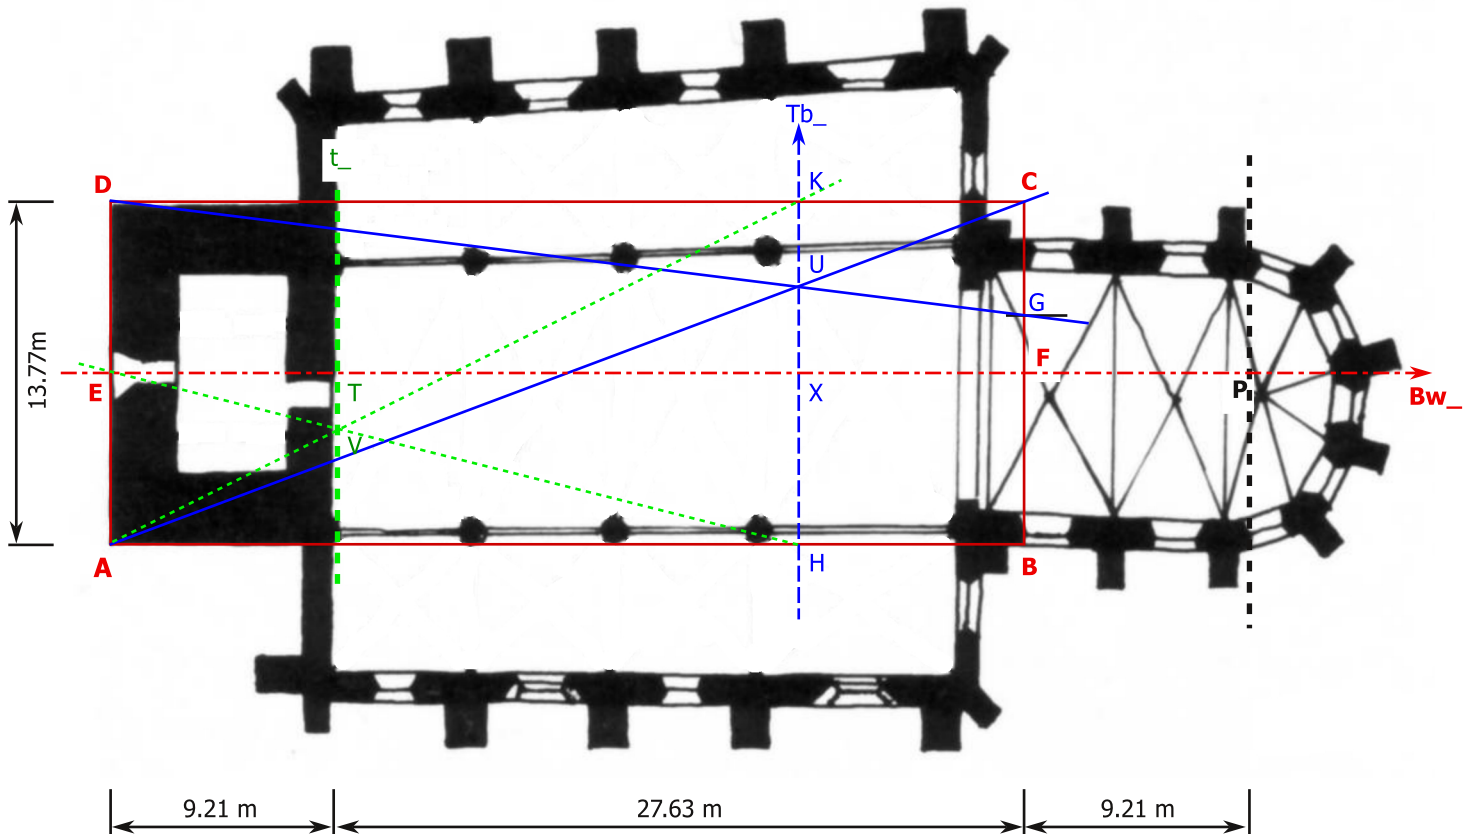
Grundriß der gotischen Hallenkirche St. Jakobi zu Perleberg. Rot: Grundrechteck der romanischen Saalkirche.
